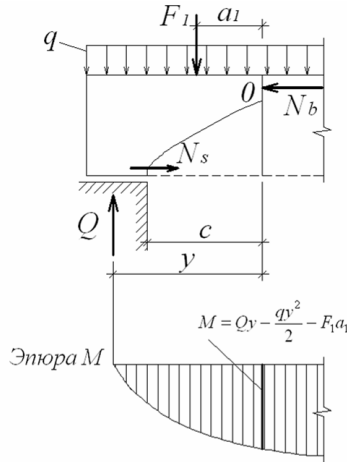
Расчетная схема для определения расчетного значения момента при расчете наклонного сечения
